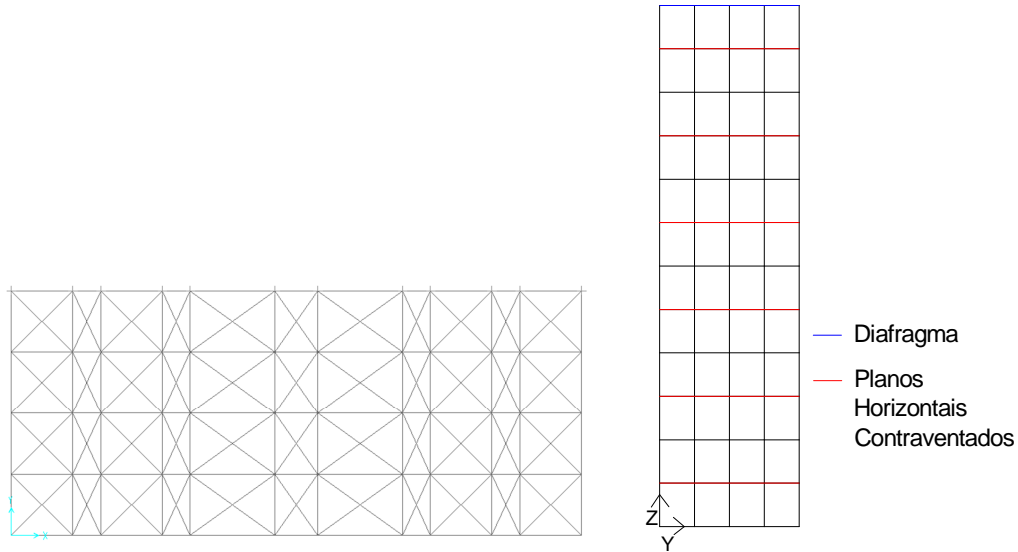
Configuração dos Planos de Contraventamento Horizontal Com Elementos de Contraventamento Pequenos
